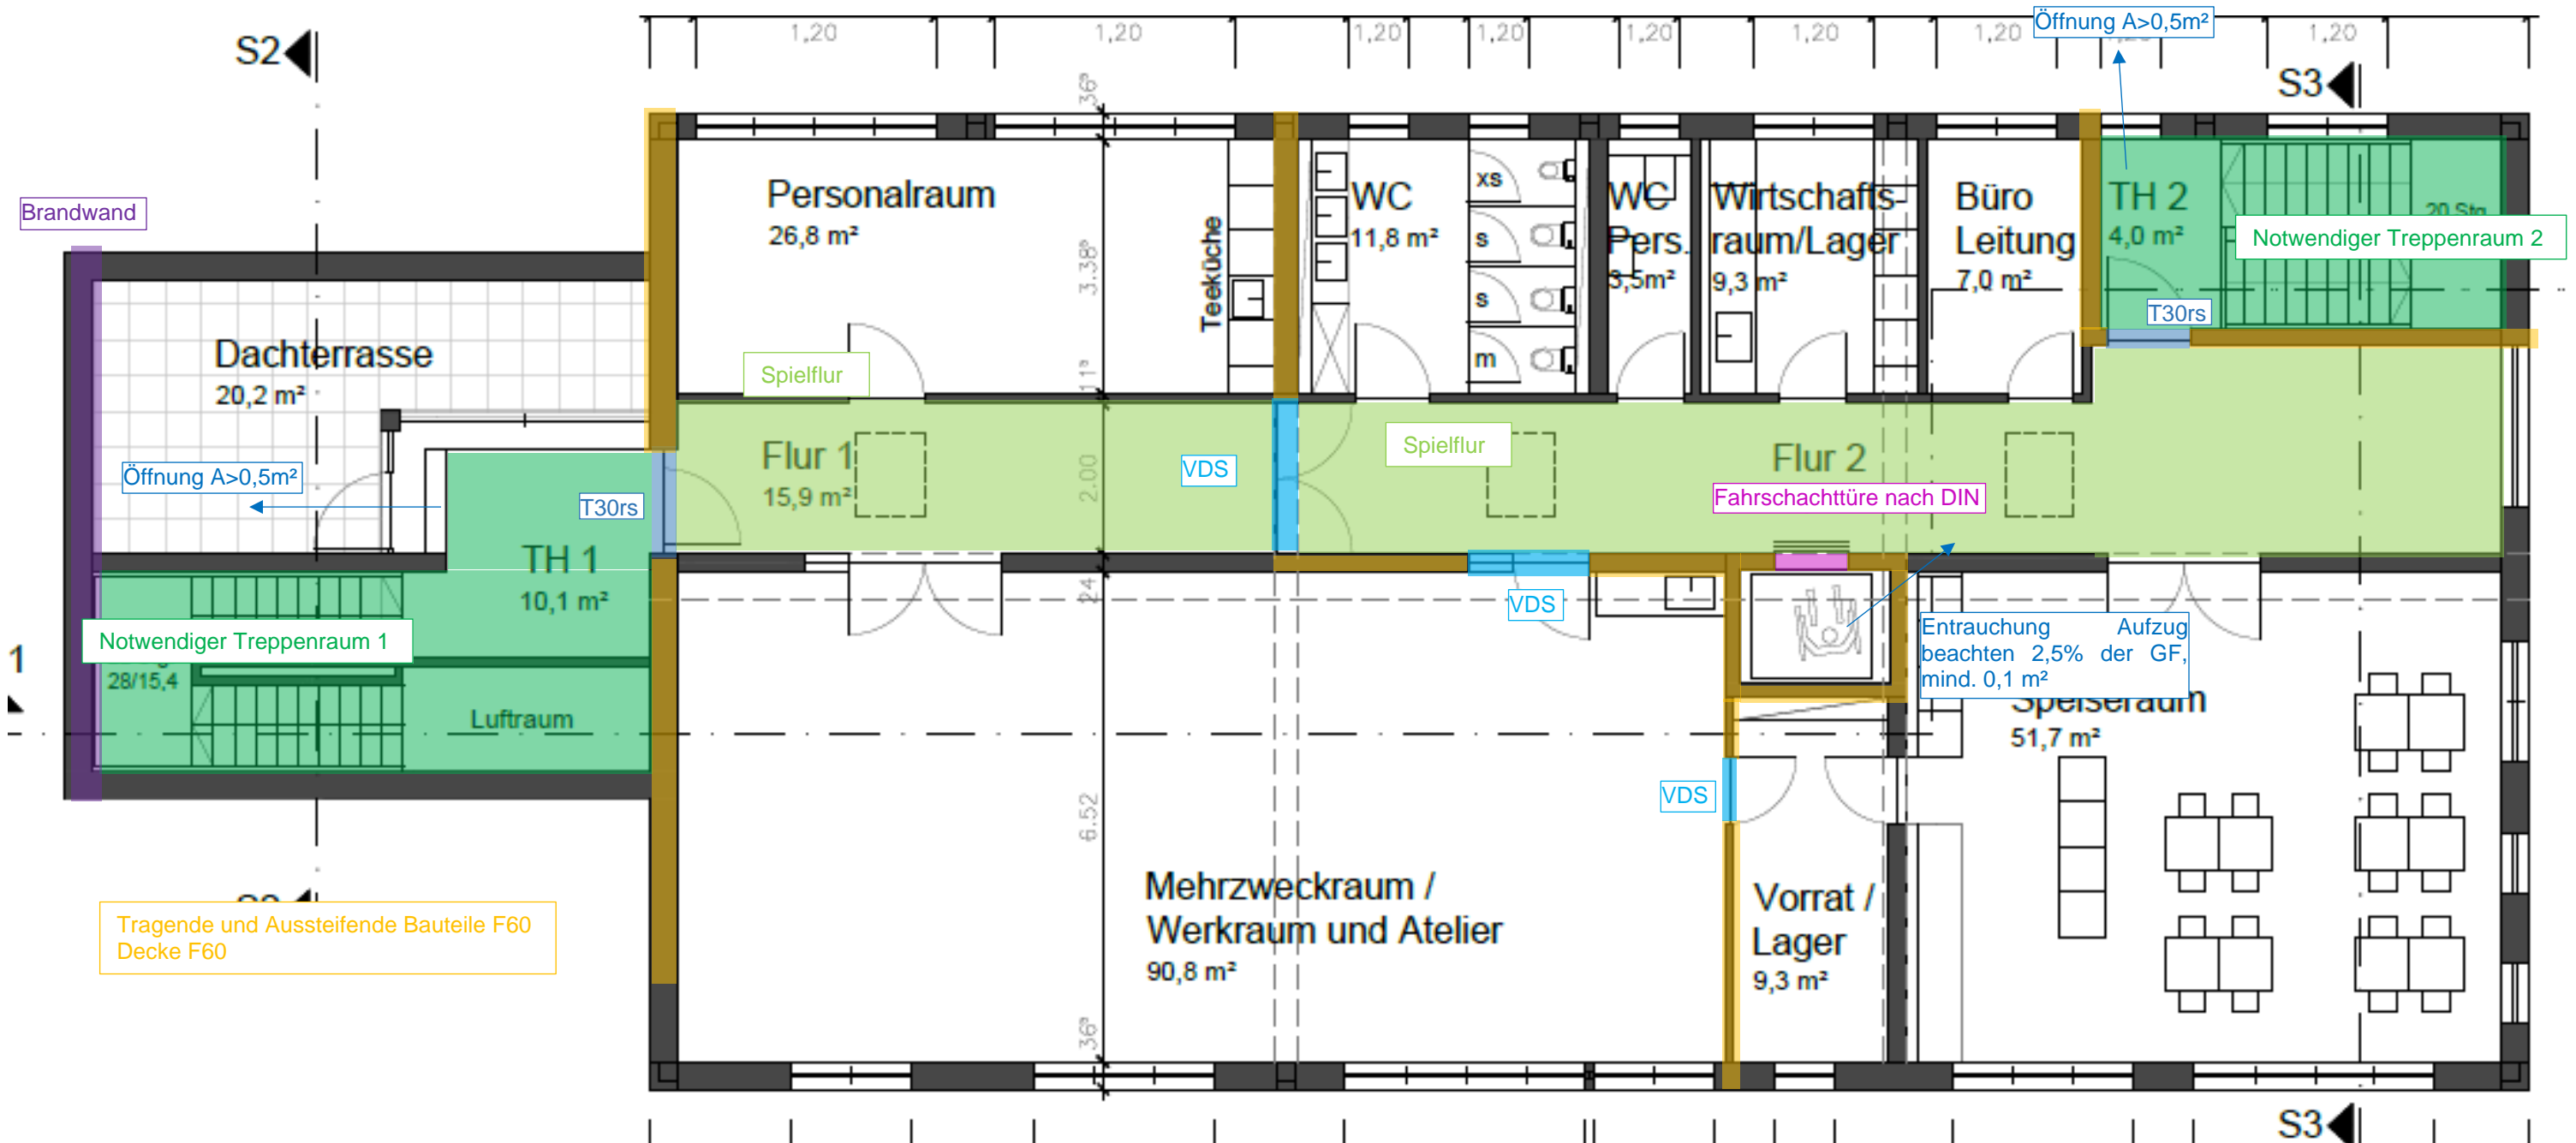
Grundriss 3. Obergeschoss
